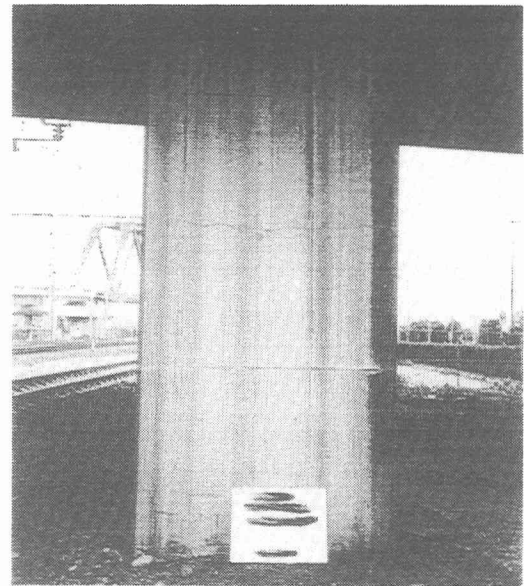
RC橋脚の輪切り状ひび割れの例
